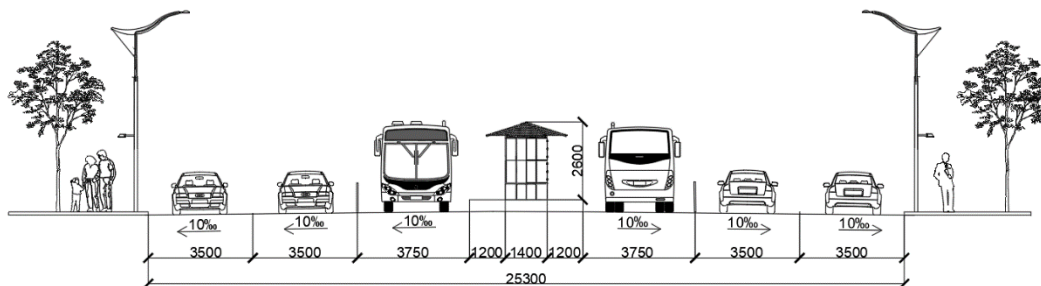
Поперечный профиль проезжей части с метробусным движением с остановочной платформой
